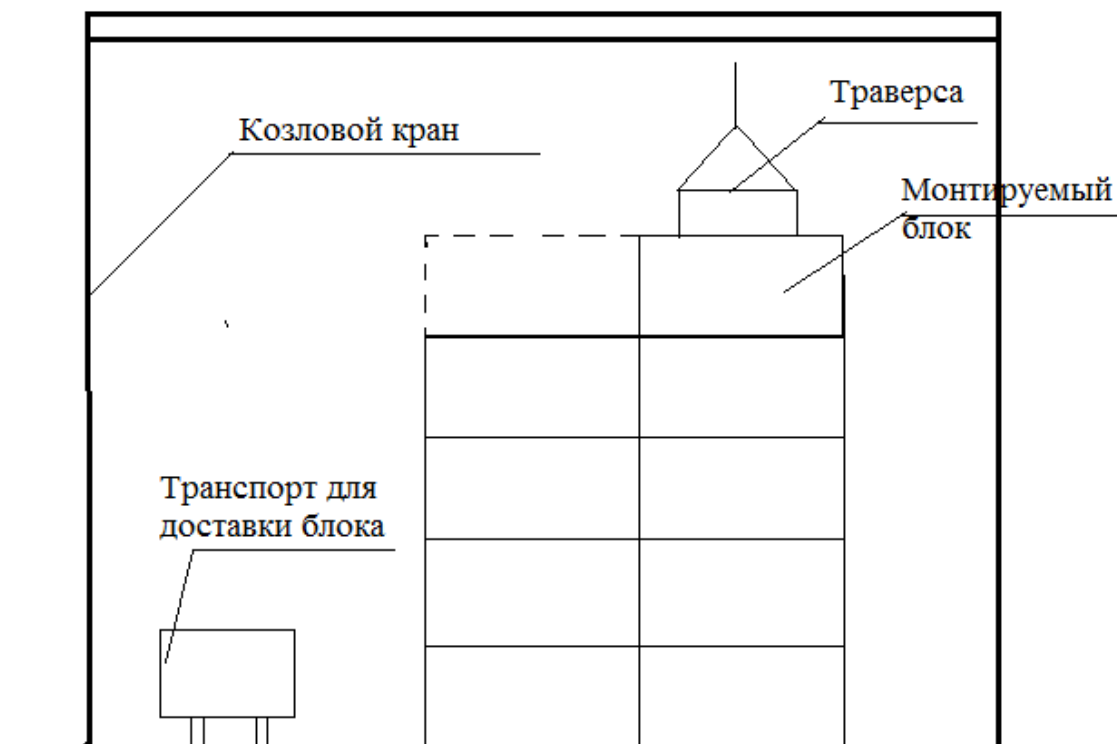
Монтаж зданий из объёмных блоков козловым краном
